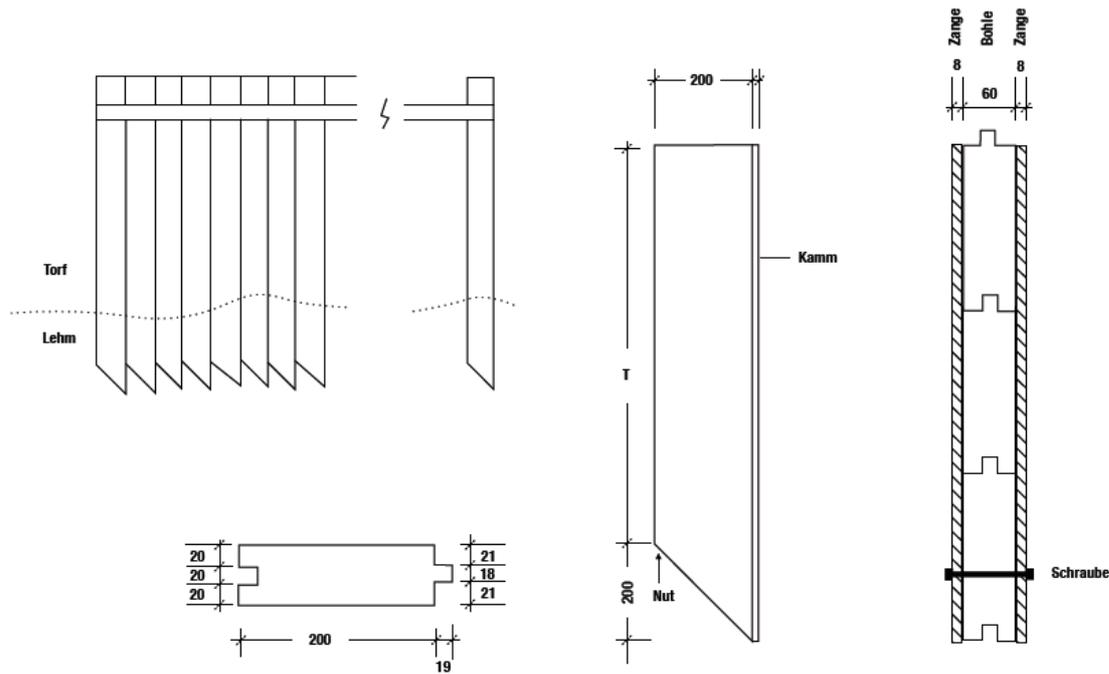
Bauplan einer Holzspundwand gemäss Grosvernier und Staubli (2009)
